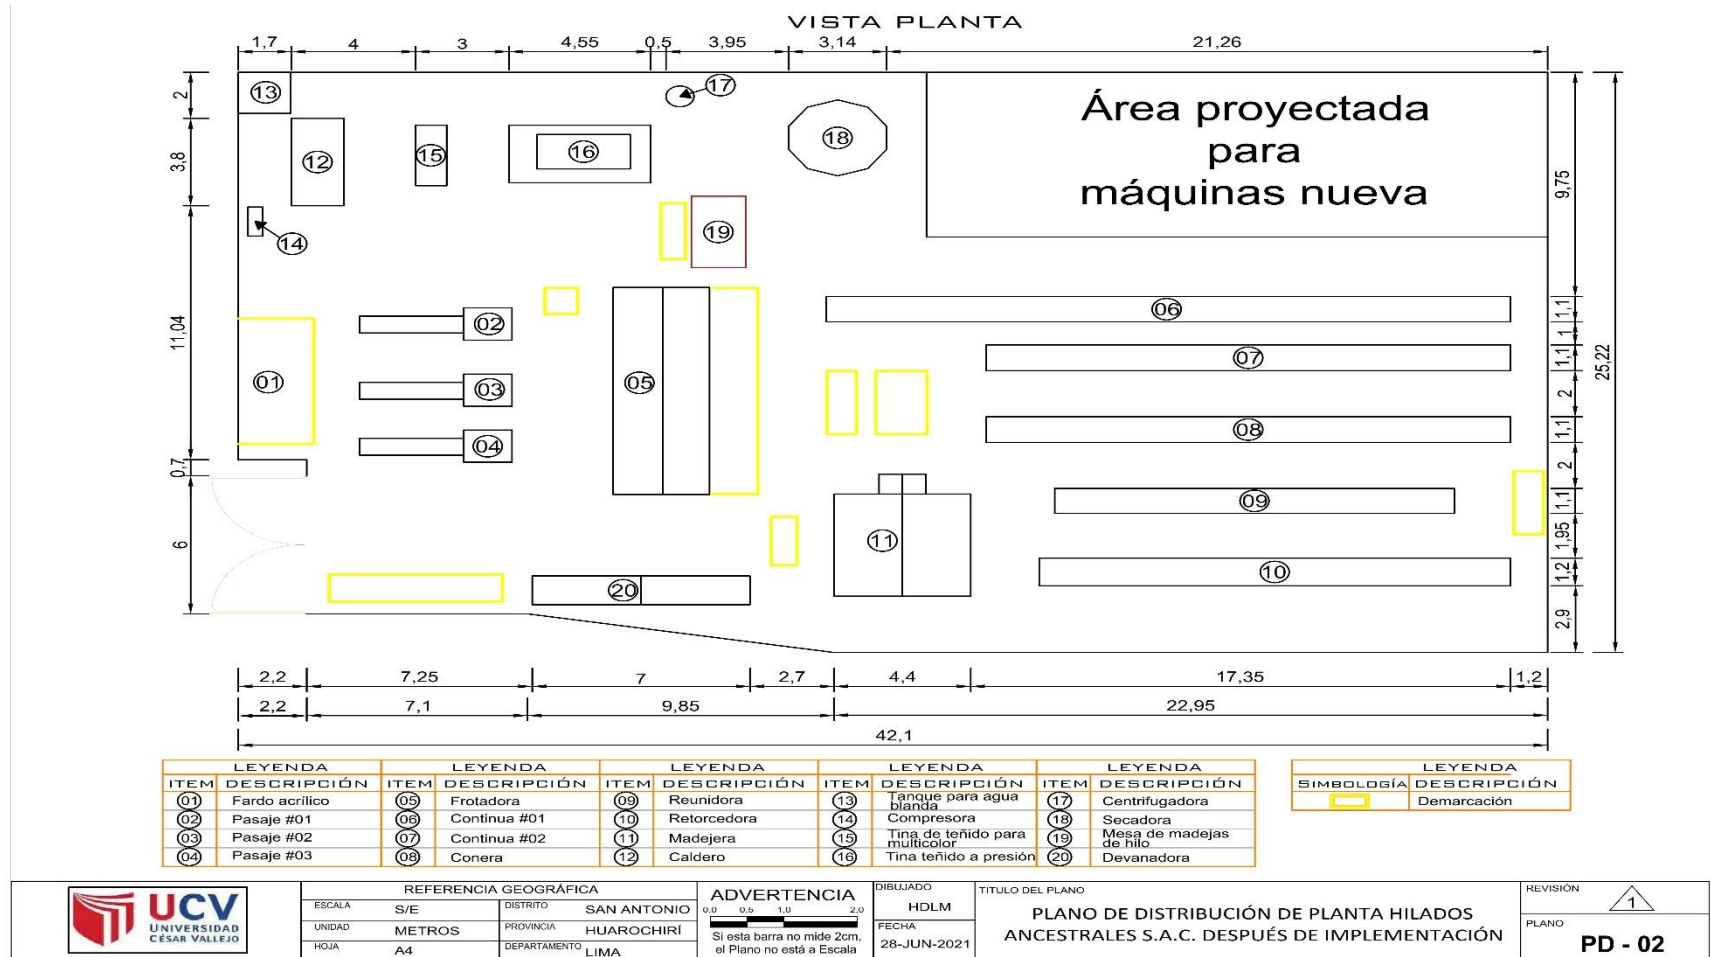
Plano de Distribución de Planta Hilados Ancestrales S.A.C posterior a la implementación de las 5S
